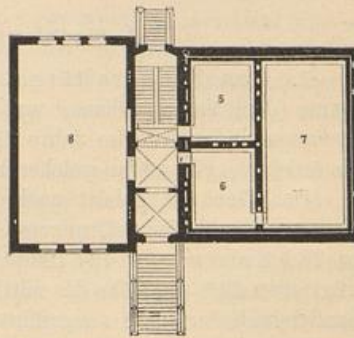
Grundriss vom Erdgeschoss. Fig. 77. Grundriss vom Hauptgeschoss.
